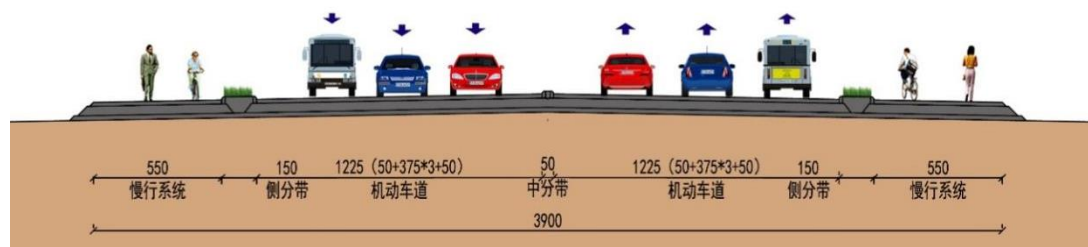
现状 G204 横断面示意图 (S232~终点)
